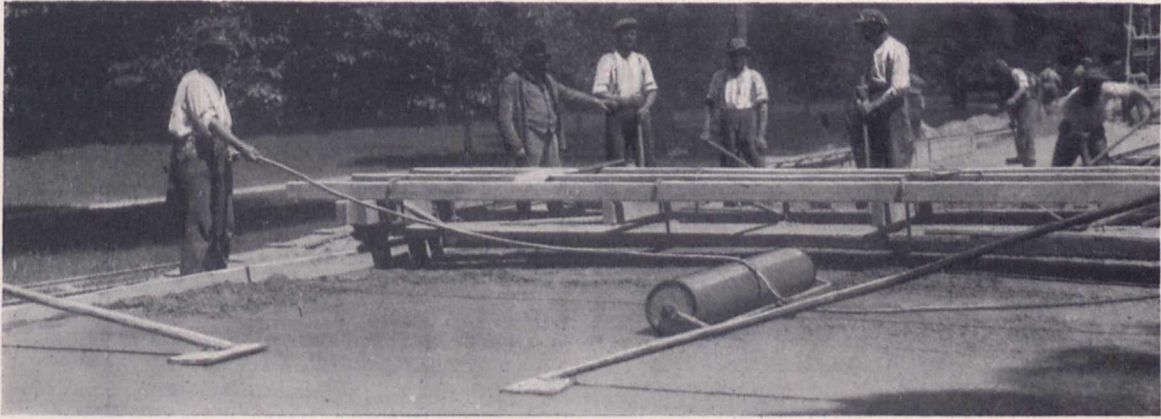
Abglätten der Betonoberfläche mittels Walze.
